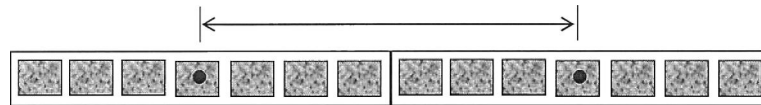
Vista en planta de la sección transversal del muro con acero de refuerzo a una separación s
